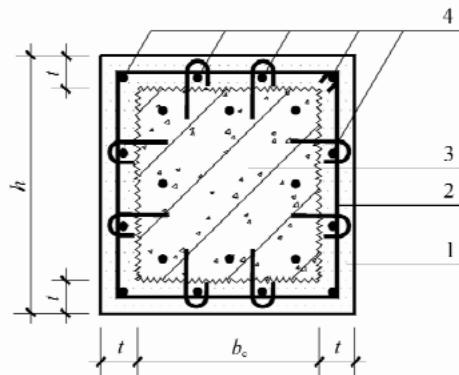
高延性混凝土围套加固钢筋混凝土柱示意图
